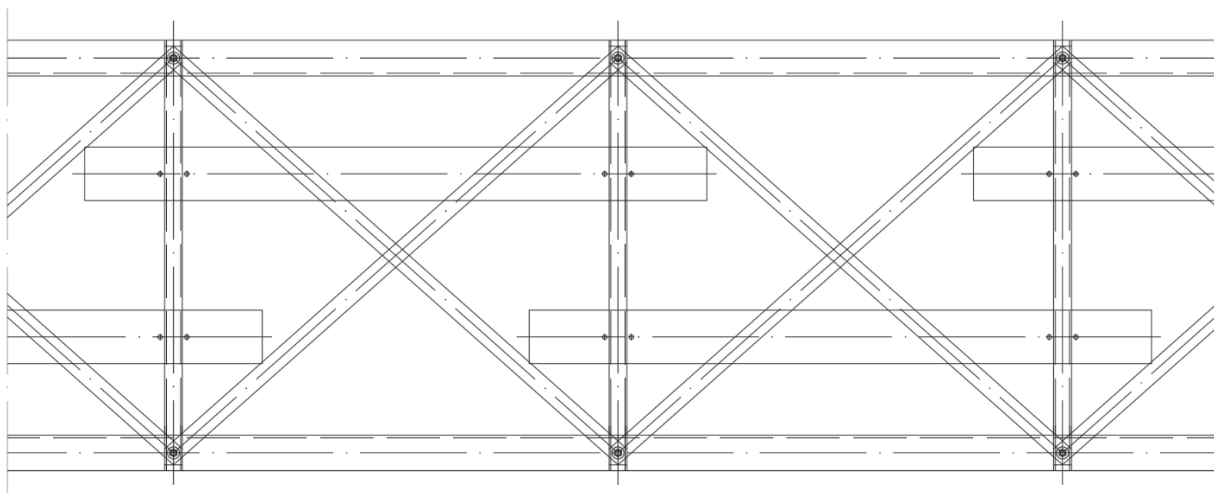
Vista em planta das barras de aço correspondentes às restantes cargas permanentes
